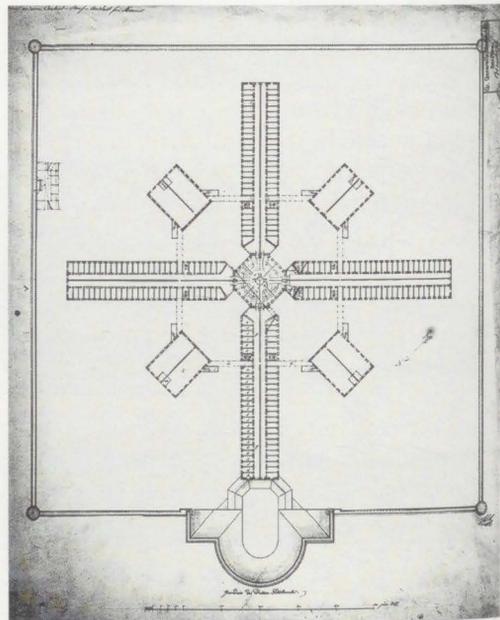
Erster Entwurf, bez. „Entwurf zu einer Central-Straf-Anstalt für Männer./ Grundriss des Dritten Stockwerks.“ sign. „Hh“. GLA, G Bruchsal 37.
